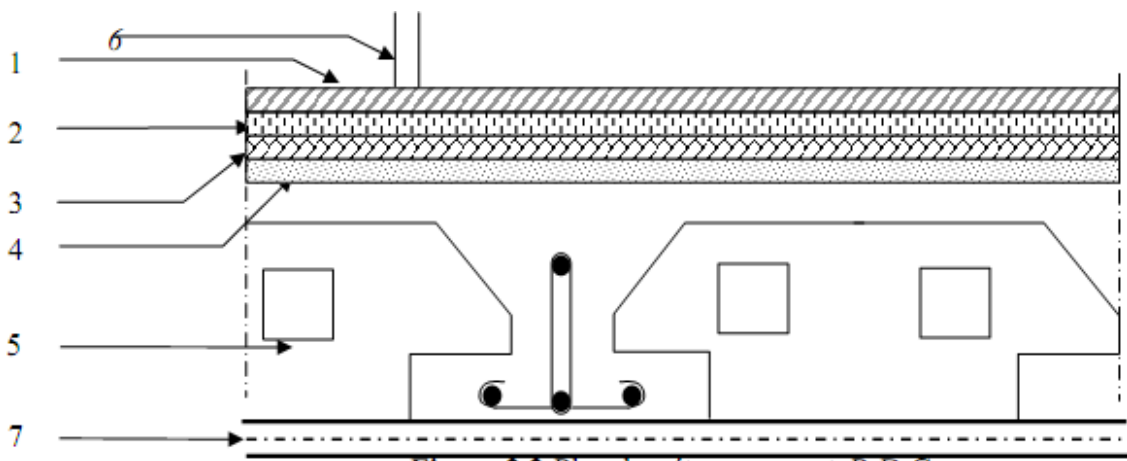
coupe transversale d'un plancher terrasse inaccessible corps creux.
